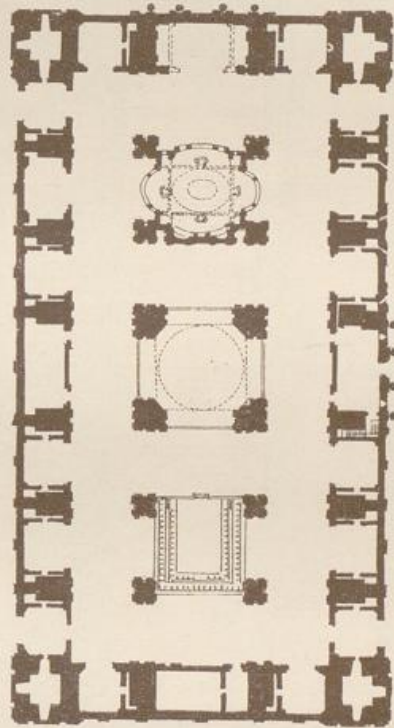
Grundriss von N. S. del Pilar zu Zaragoza (n. Fergusson).
